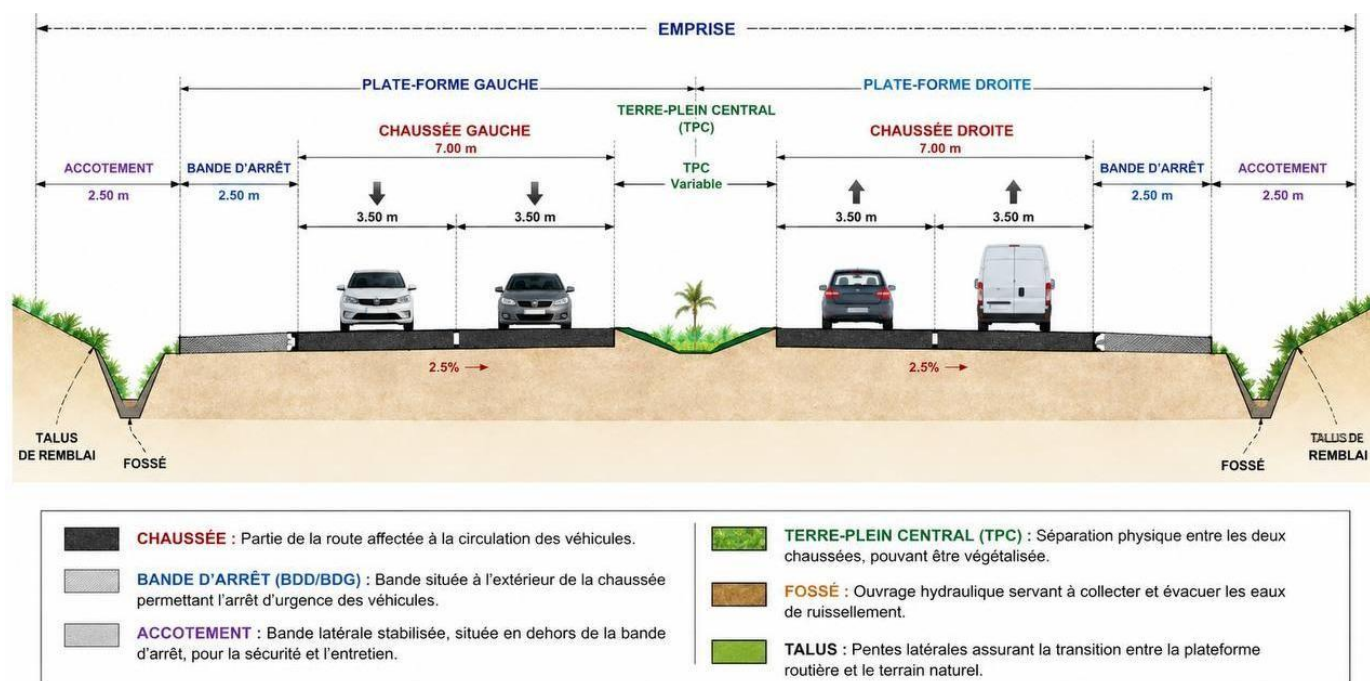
Éléments constitutifs du profil en travers à 2×2 voies.
